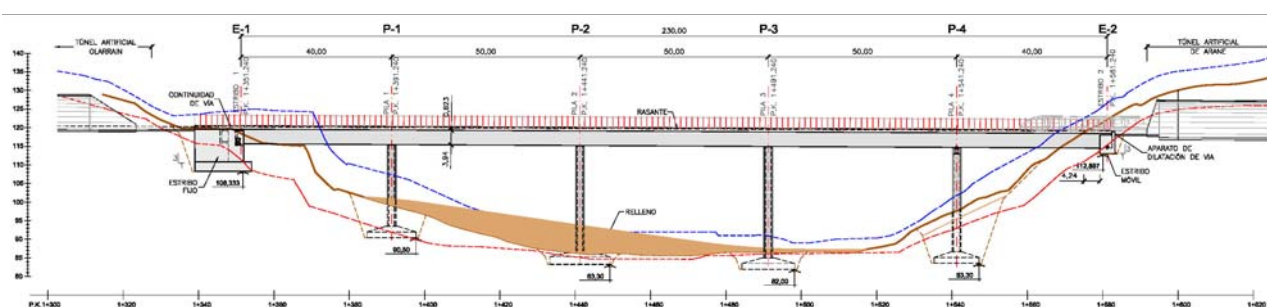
Alzado correspondiente al Viaducto sobre la Cantera de San Esteban.
